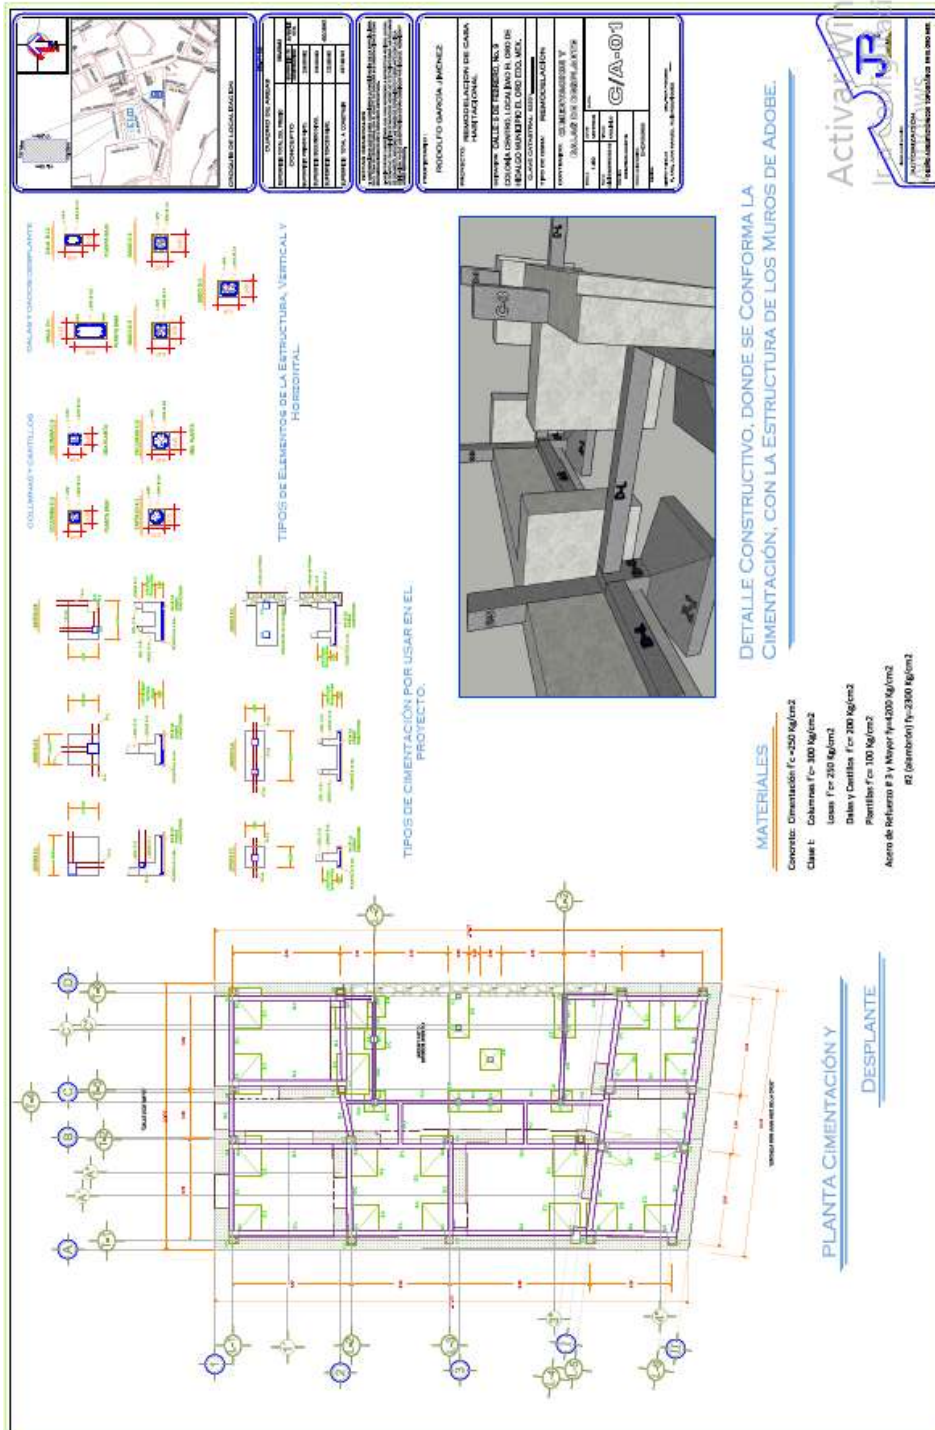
Imagen del Plano resultante de la propuesta del tipo de Cimentación, así también el tipo de dala de desplante, como dados y columnas. Se presenta una detalle constructivo de la forma como se integra la cimentación de forma conjunta con los muros de adobe para su reforzamiento, además una especificación del tipo de material a utilizar.
